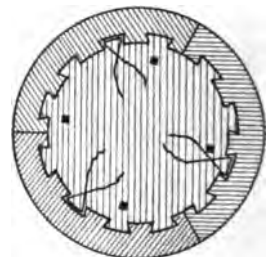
Ummantelung einer Säule von kreisrundem Querschnitt mit Terrakottaplaten.
